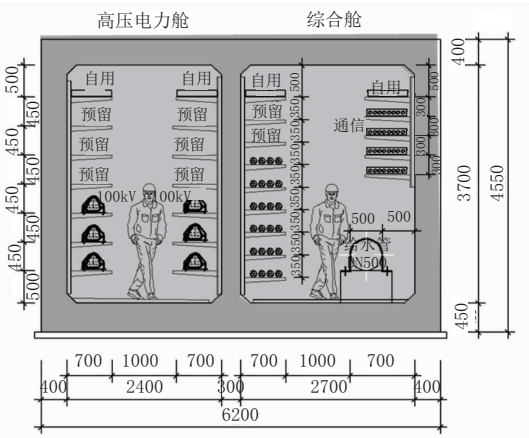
仓宁路标准段综合管廊横断面图(单位:mm)
